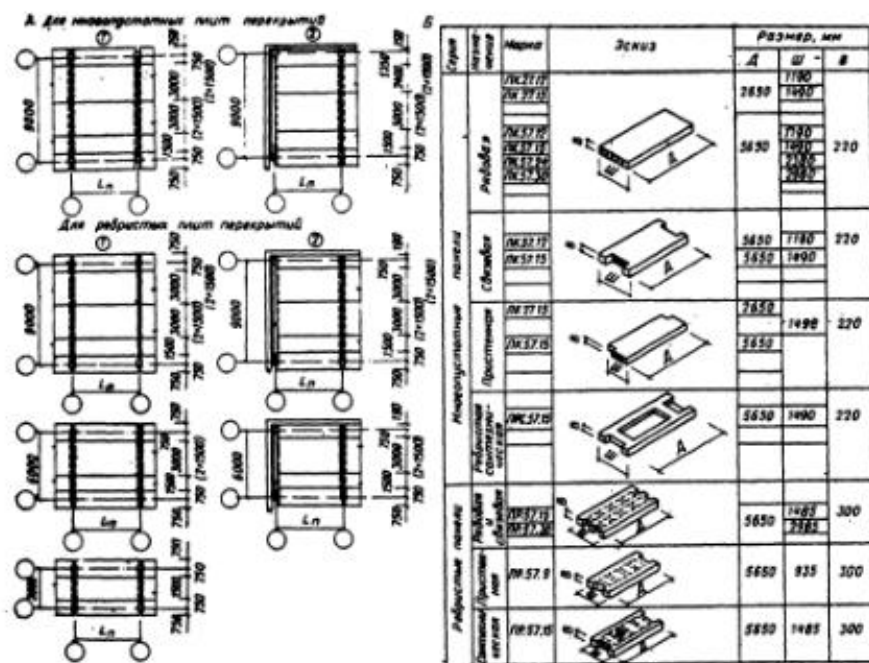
Примеры решений планов перекрытий: А - монтажные схемы компоновки плит перекрытий в средних (1) и крайних (2) пролётах; Б - номенклатура панелей
